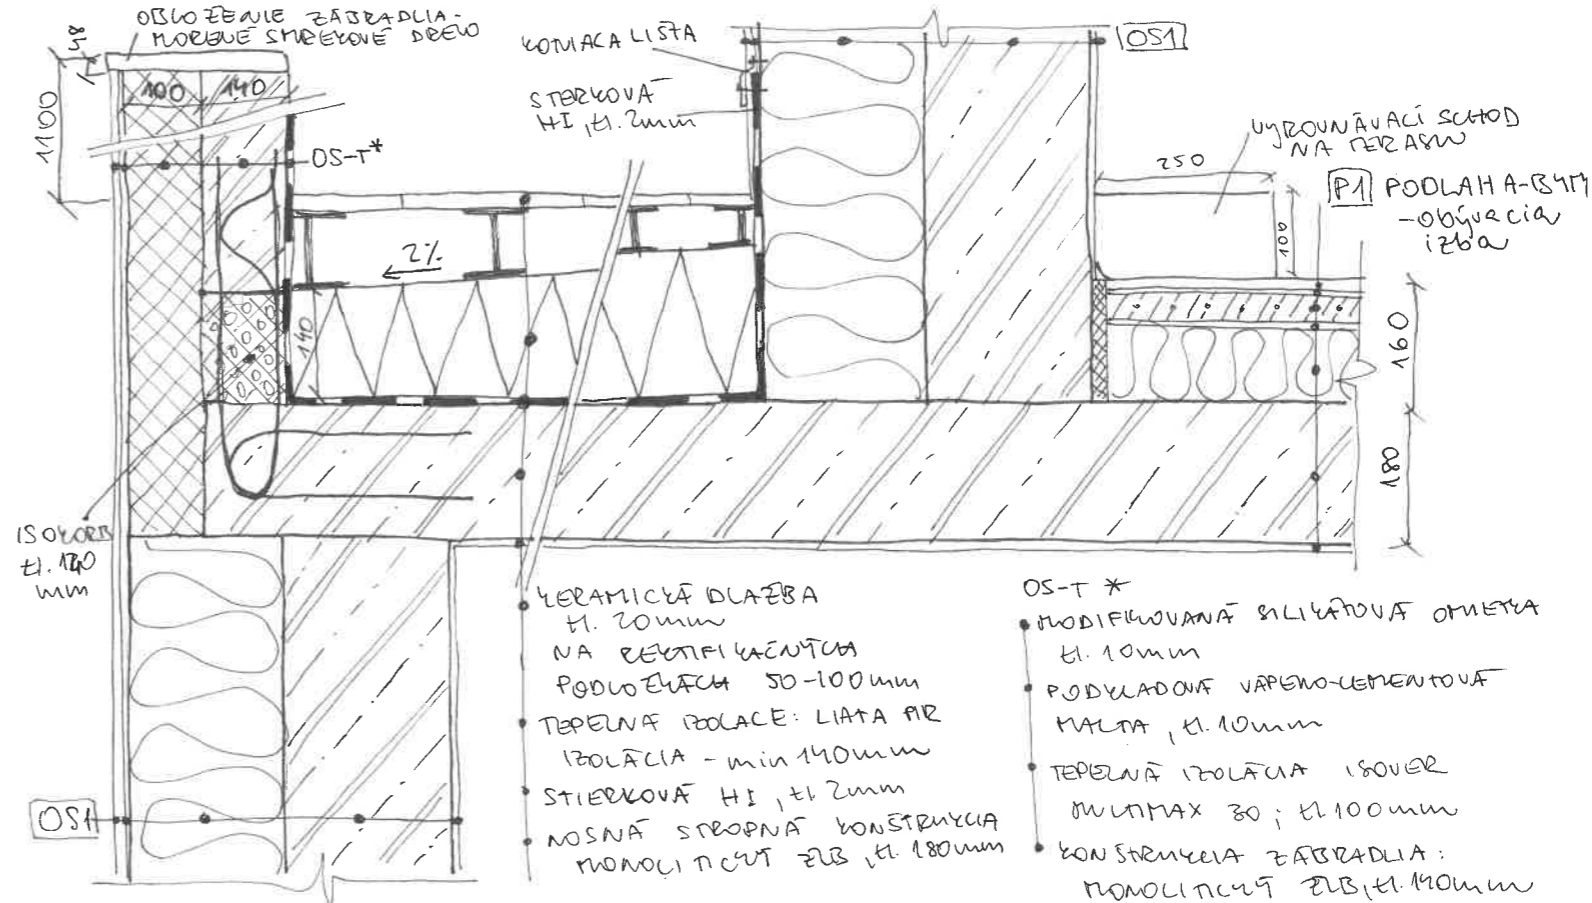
PRECHOD BALCÓN - INTERIĚR M 1:10
